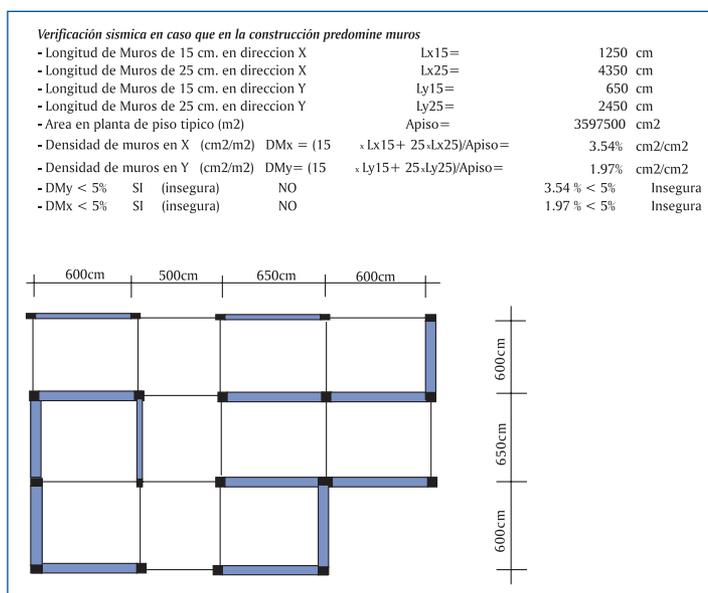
Ejemplo de Aplicación de estructura de muros de albañilería
